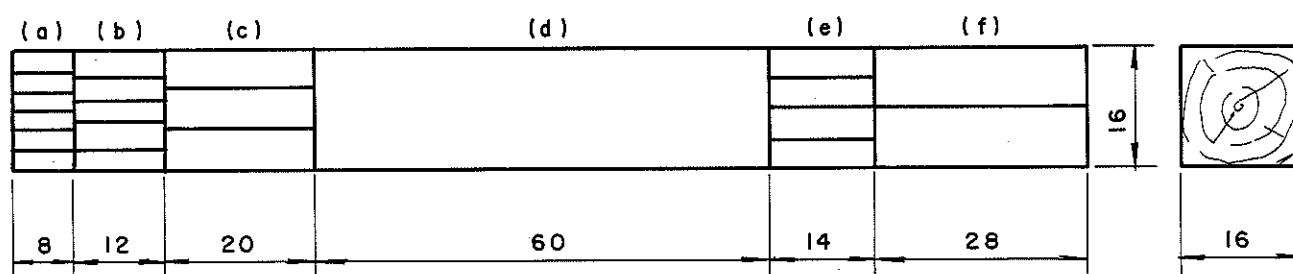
Corte dos corpos de prova; vista lateral igual à vista superior (dimensões: cm).
